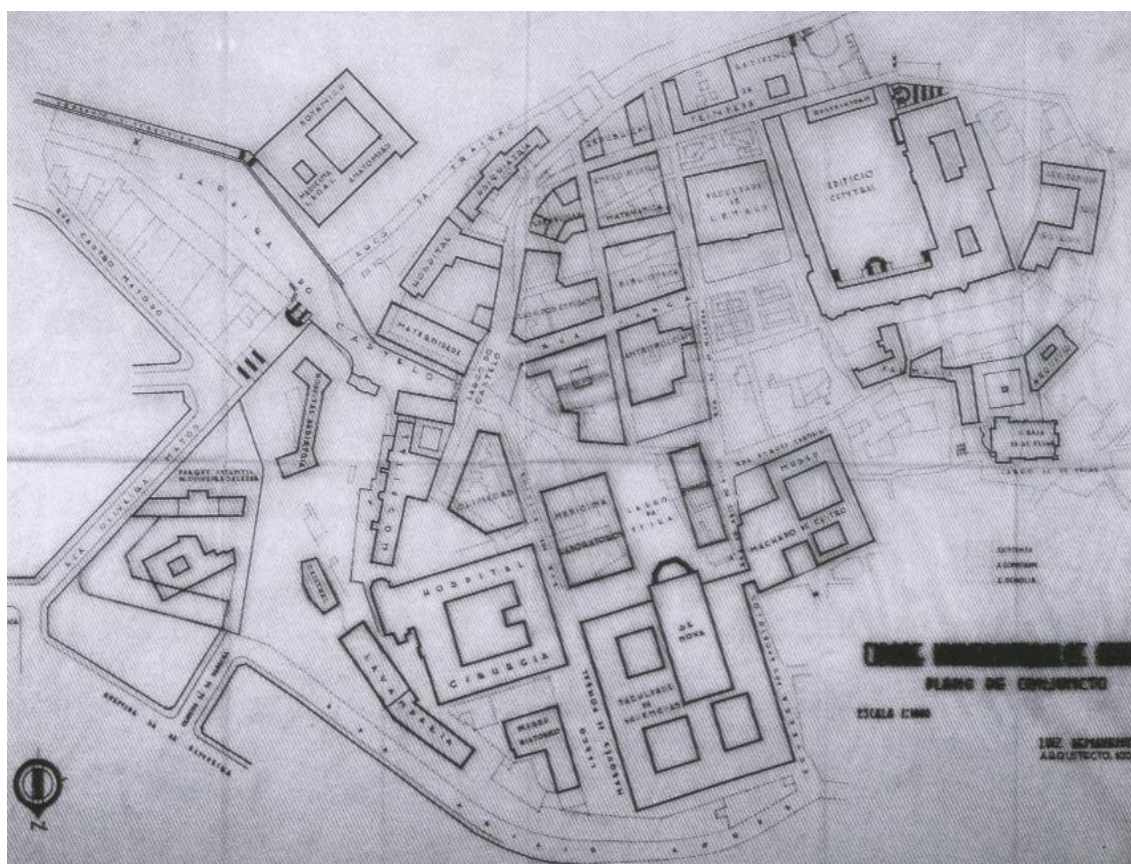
Planta de conjunto da Cidade Universitária de Coimbra (Luís Benavente e Raul Lino, 1934).
